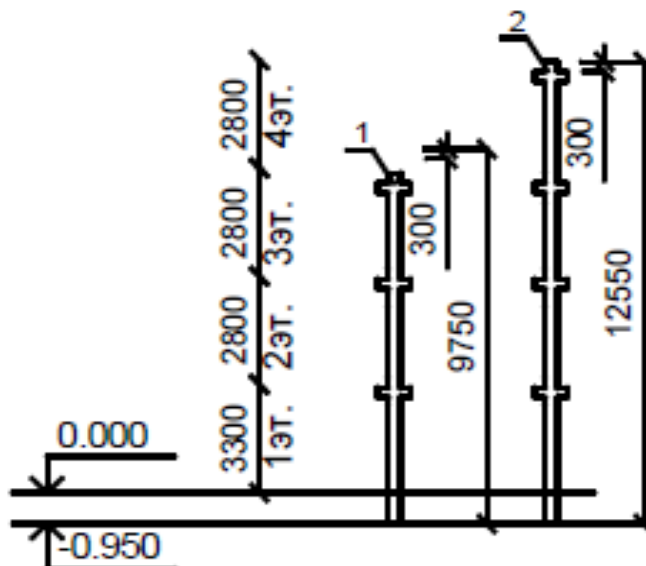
Колонны каркаса сечением 300х300 мм для зданий без подвала с высотой первого этажа 3300 мм и высотой верхних этажей 2800 мм
